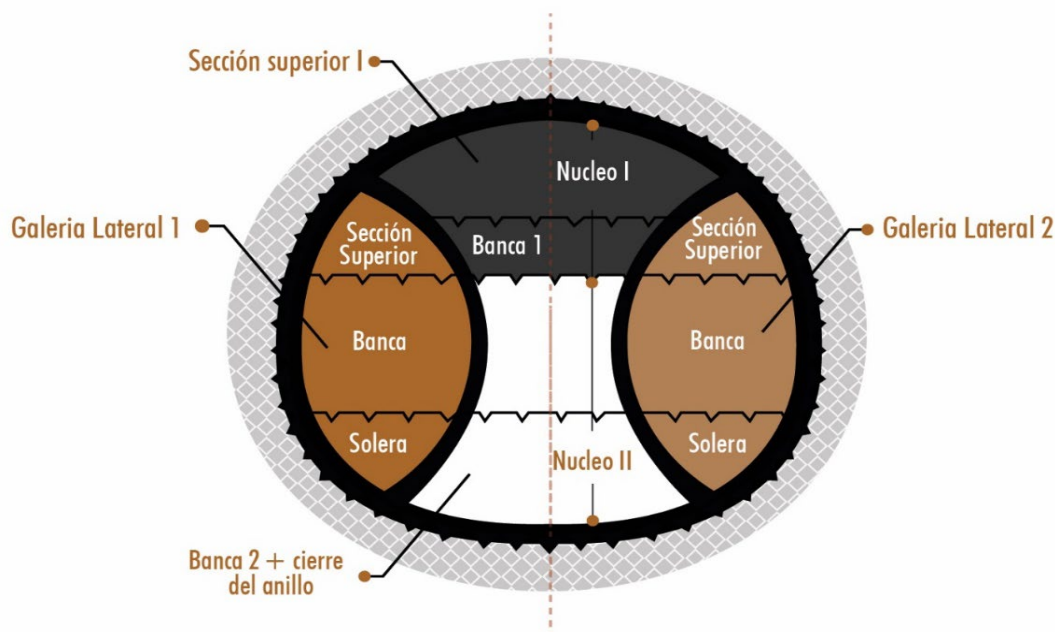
Fases de excavación - sección transversal con núcleo central
